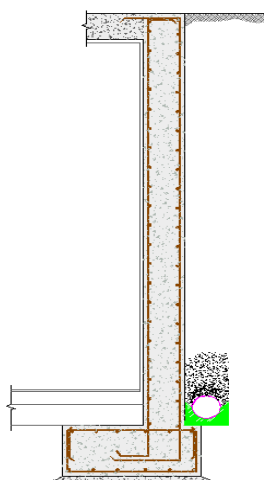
Muro em betão armado sobre sapata contínua excêntrica
